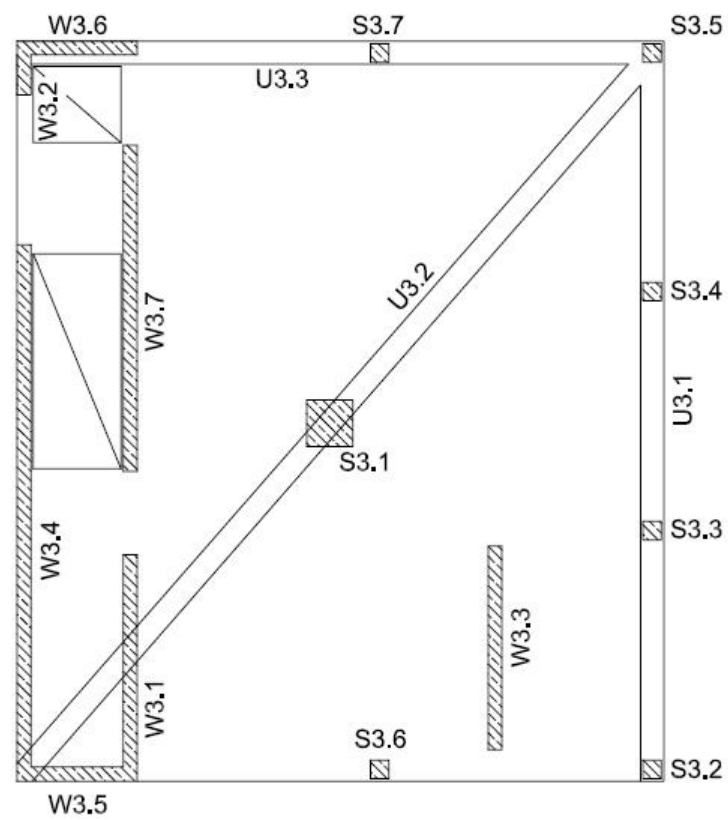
Bürogebäude X: Grundriss 2. OG [Lie09]
